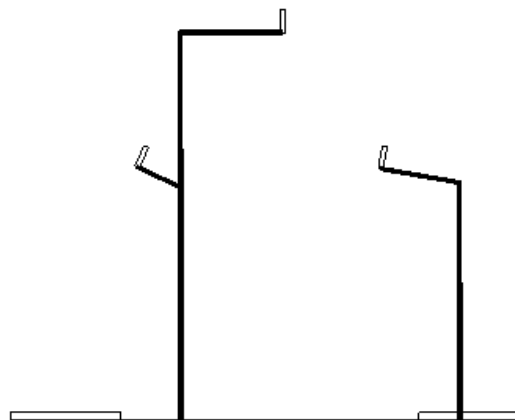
Vista en planta y corte del diseño del malecón en DIALUX
